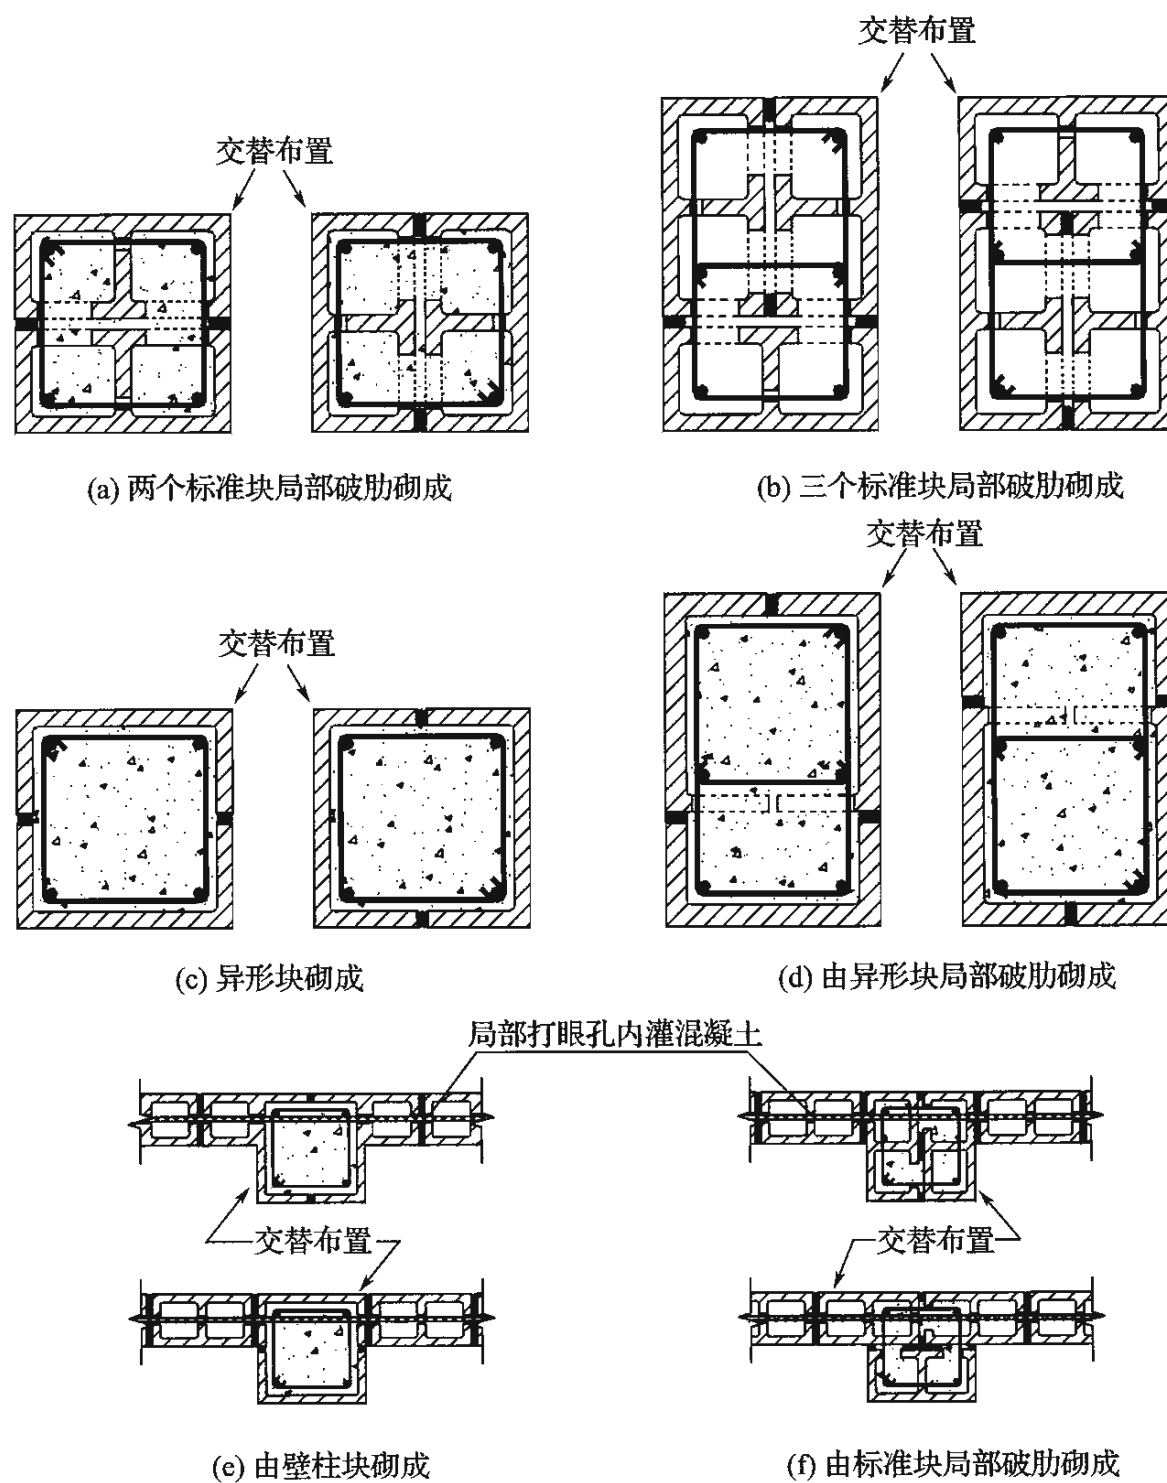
配筋砌块柱、壁柱配筋形式
